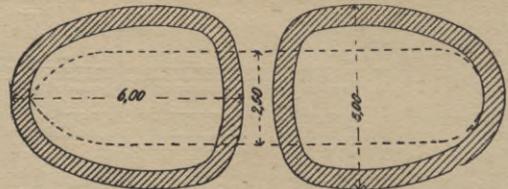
Senkbrunnenquerschnitt, dem Grundriß des Bauwerks angepaßt.
